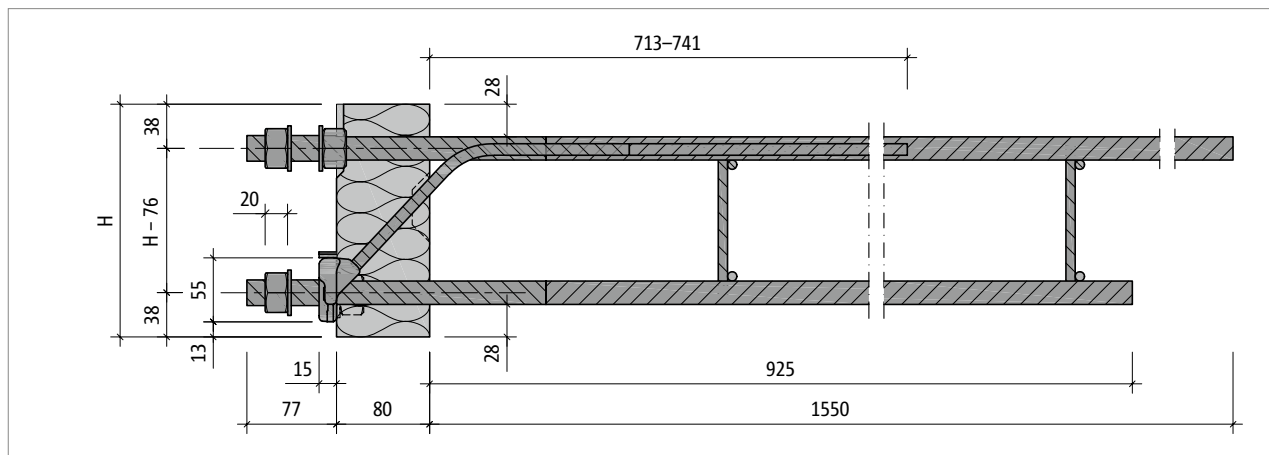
Schöck Isokorb® T type SK-MM2-VV1 : coupe du produit
